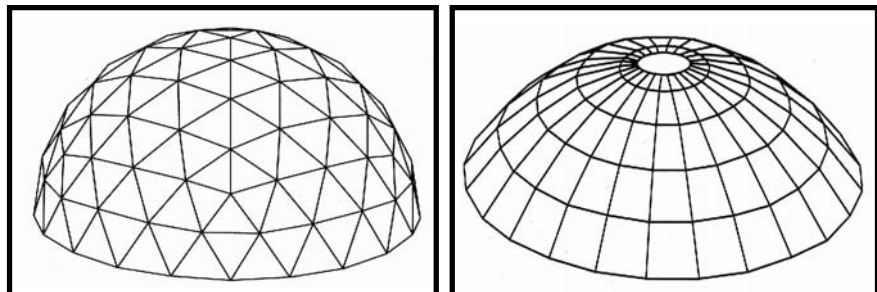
Gekrümmtes Fachwerk und Stab-Knoten-Tragwerk [37]
